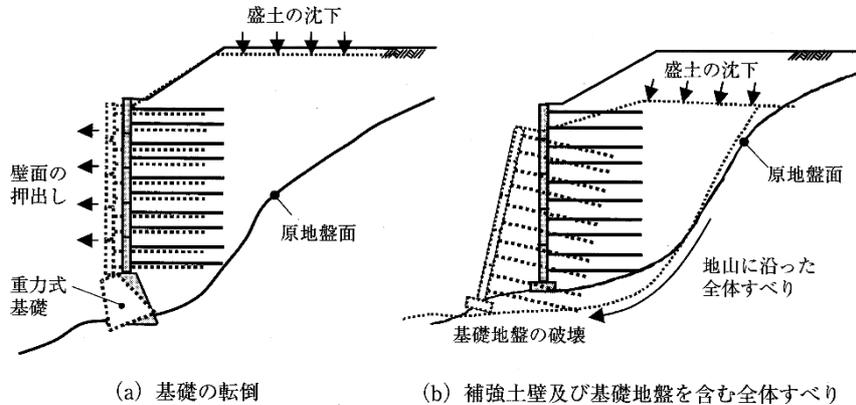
急峻な地形での補強土壁の変状事例⁸⁾
